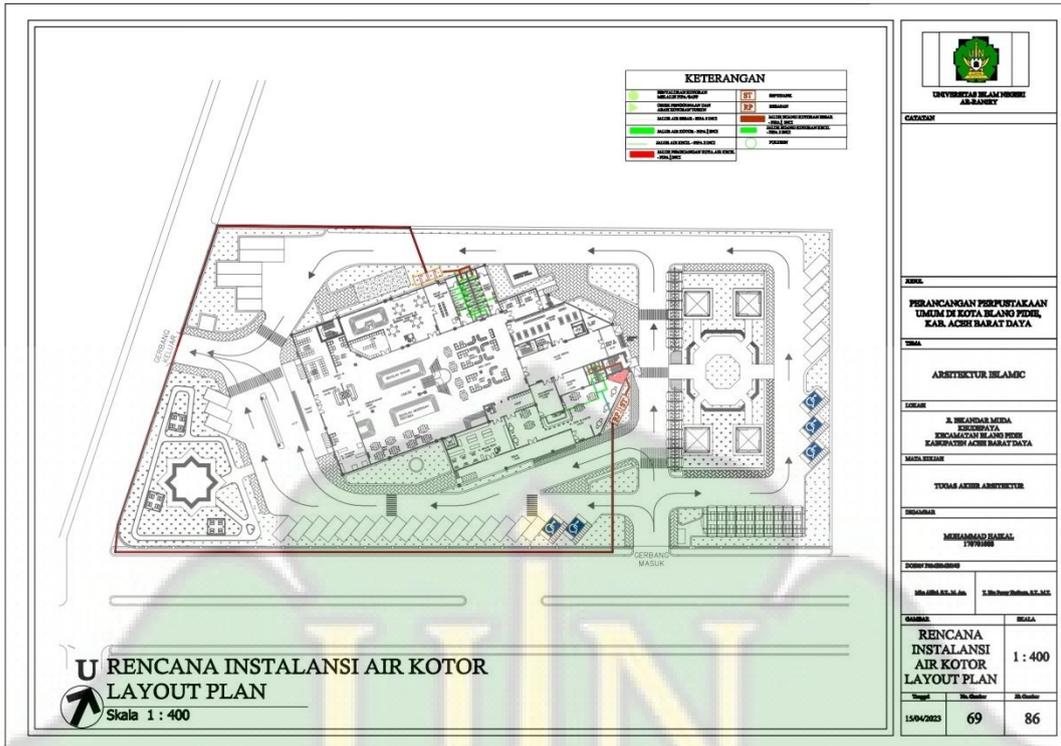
Rencana Instalansi Air Kotor Lantai I
